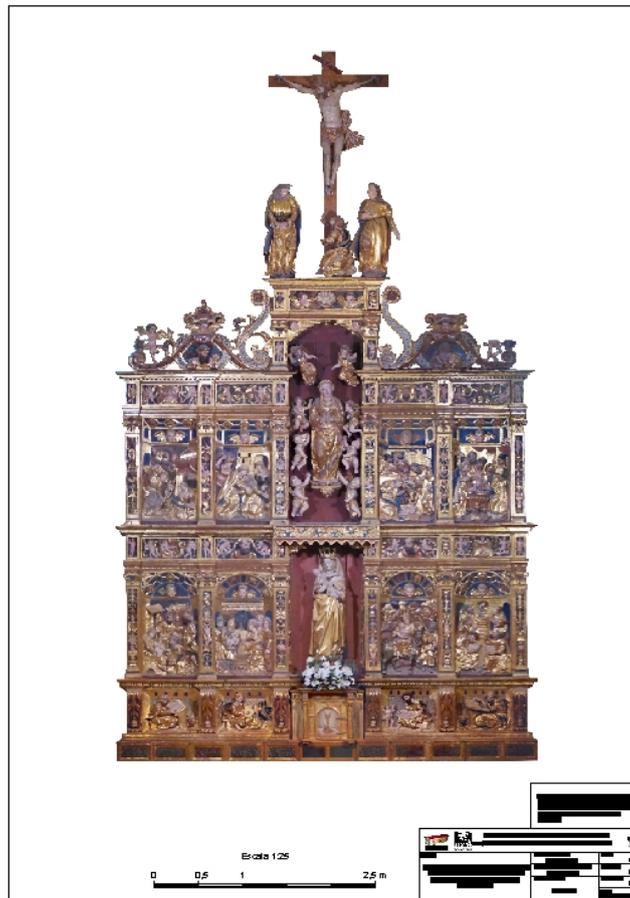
Plano a escala 1:25 del alzado del altar mayor.
